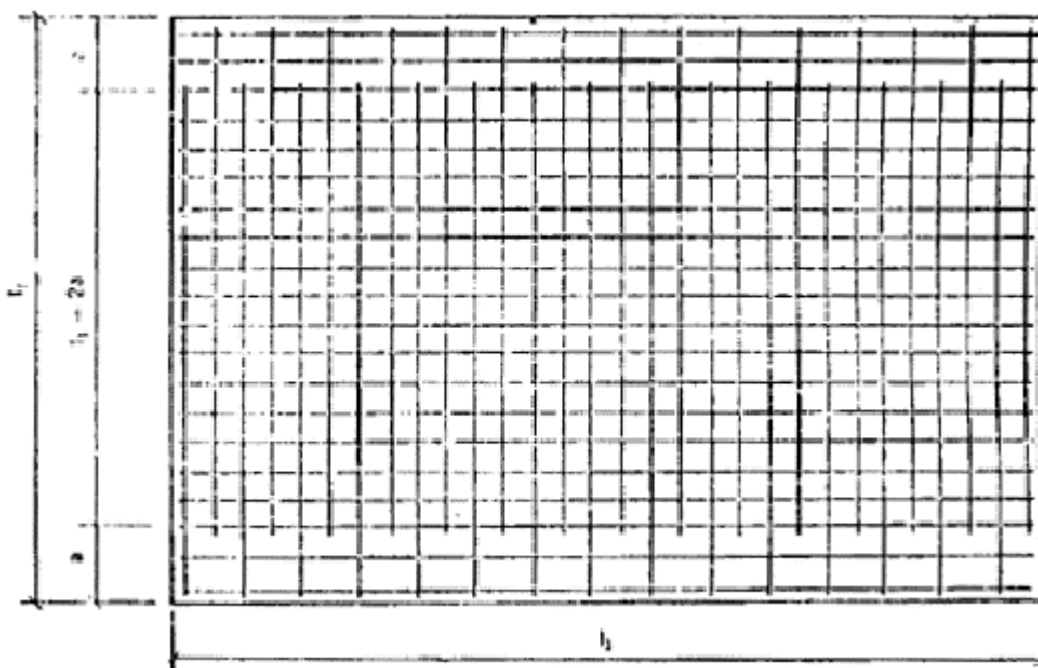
Схема к примеру расчета сборной плиты перекрытия, опертой по контуру
